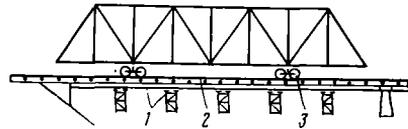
Размещение пролетного строения на тележках для продольной перекачки:
